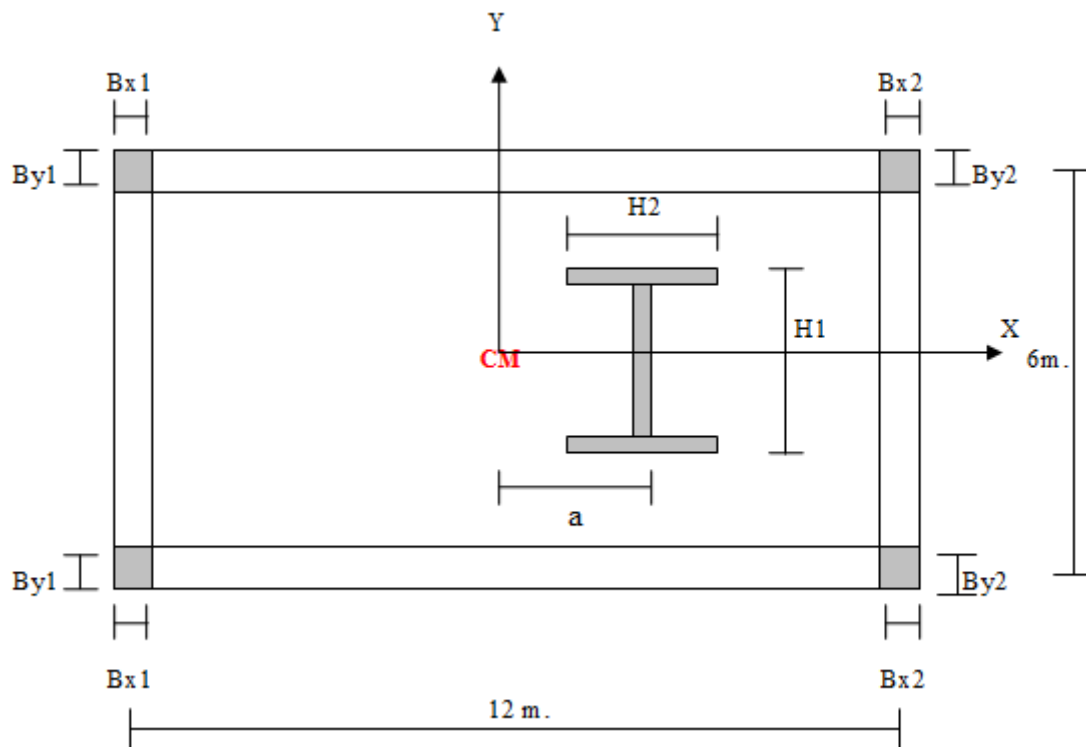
Planta del modelo estructural del edificio de concreto armado de un piso
